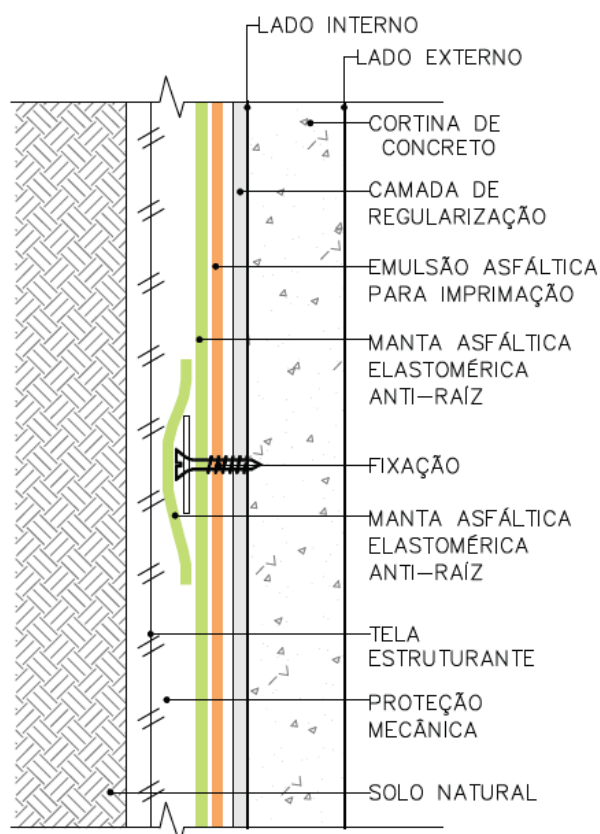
Sistema de Impermeabilização em muro de arrimo
